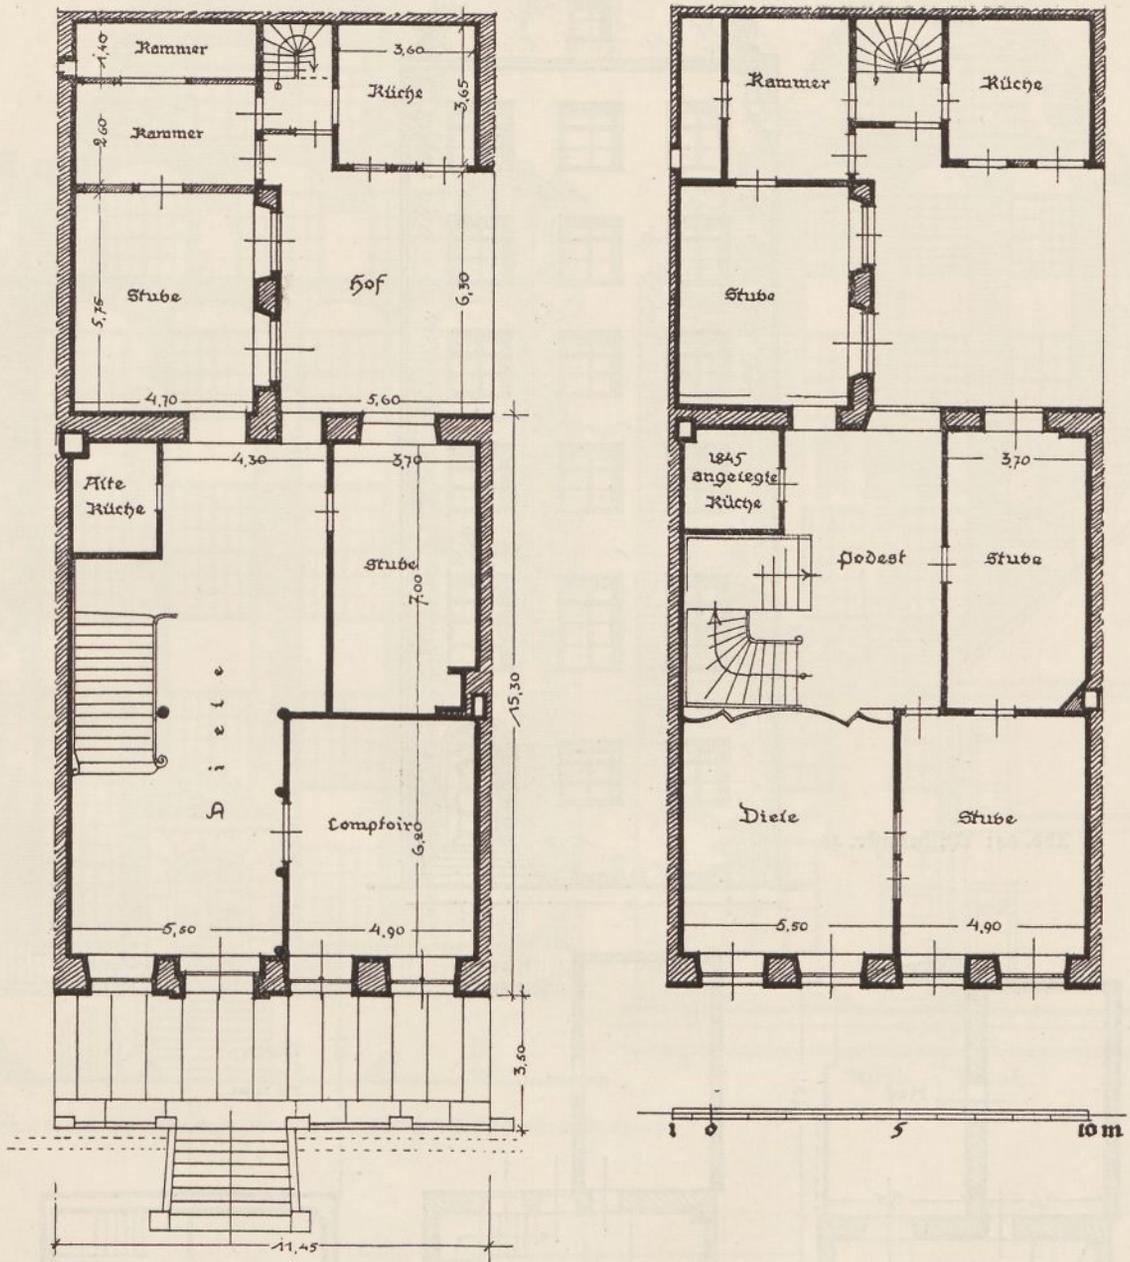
und 63: Spieringstr. 30, Grundrisse vom Erd- und Obergeschoß
